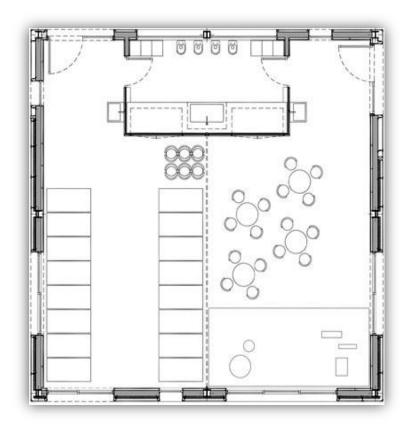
Planta amoblada de salón de niños, Guardería "Els Daus" Fuente y Elaboración: AIA Salazar-Navarro
